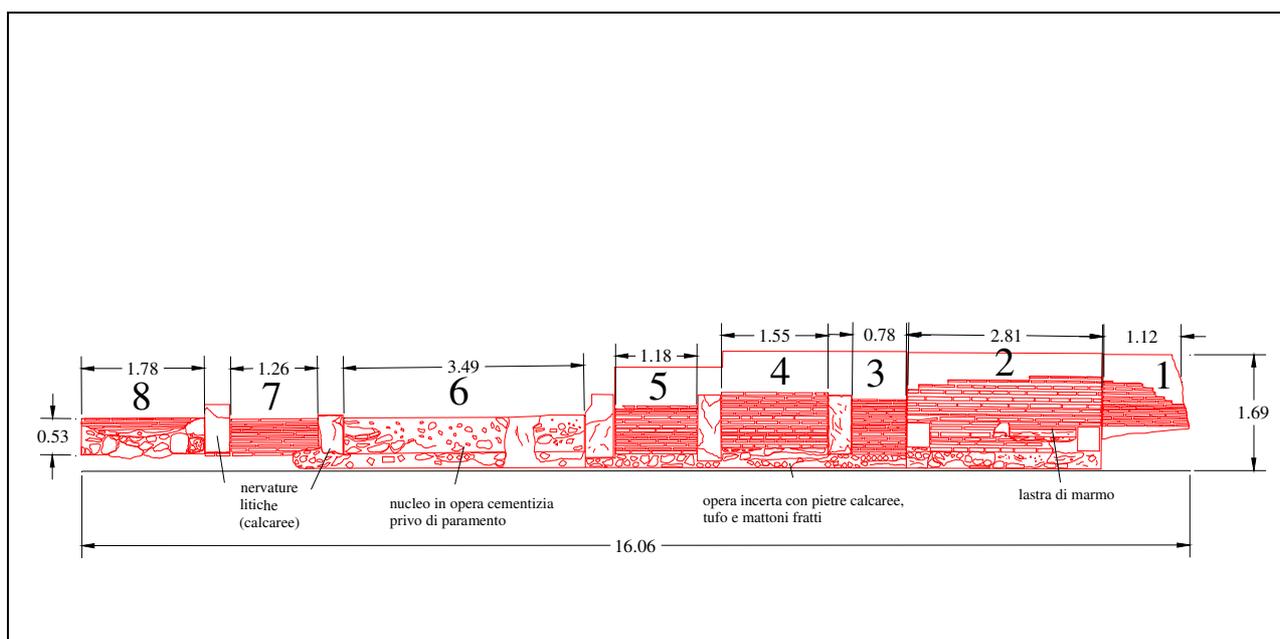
prospetto muro perimetrale lato nord, di Alessandra Iodice.
